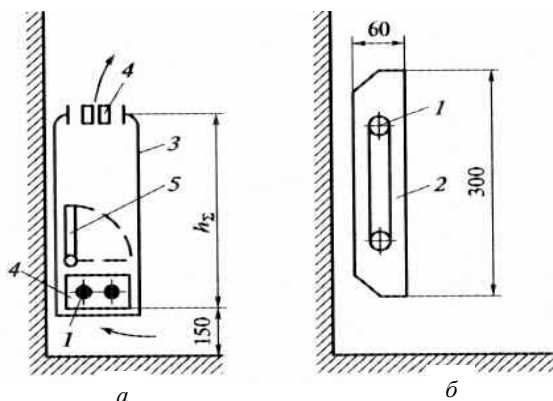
Типы конвекторов: *а)* с кожухом; *б)* без кожуха; 1, 2 – подогревательный элемент; 2 – оребрение; 3 – кожух; 4 – решетка; 5 – воздушный клапан
